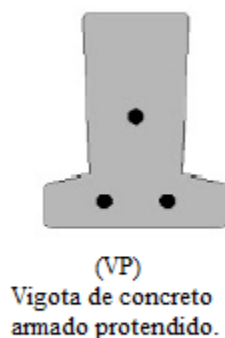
Seção transversal de uma vigota tipo concreto protendido.
